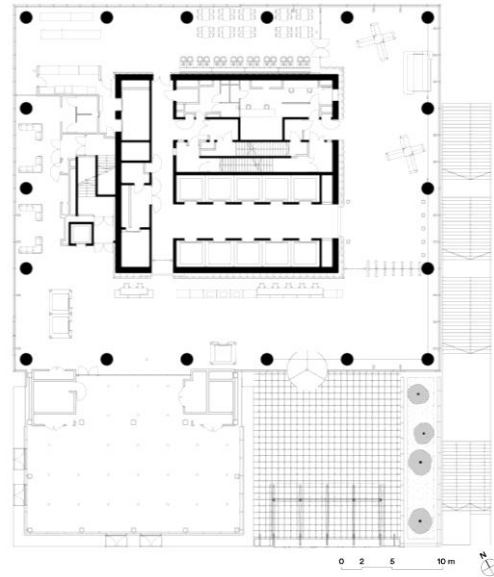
Planta ras de chan Tour Saint-Gobain
